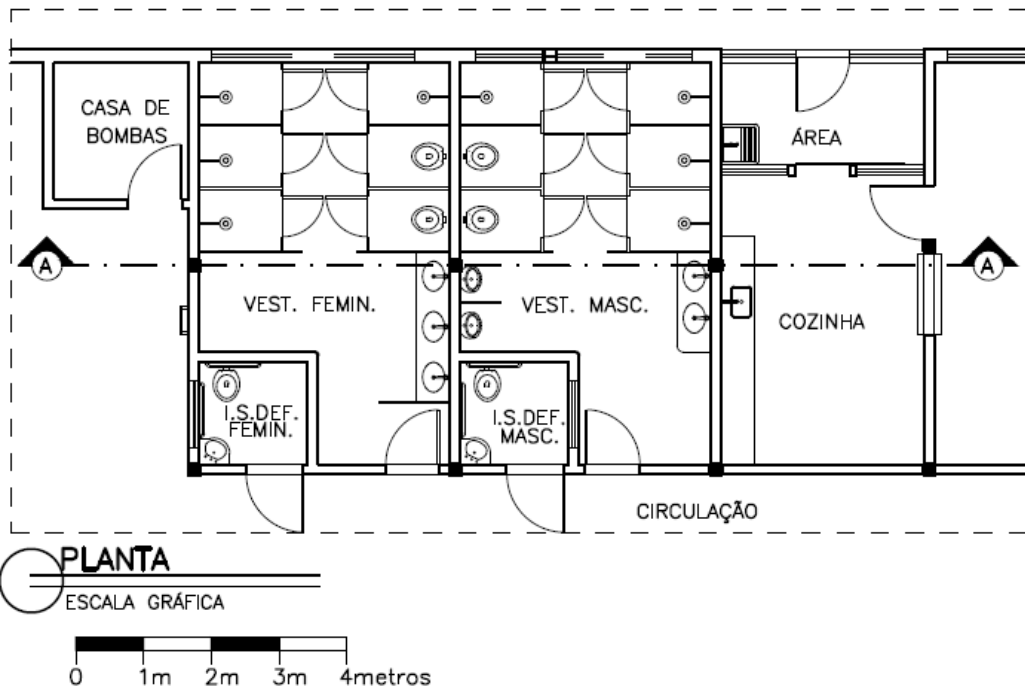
Planta Baixa do trecho dos vestiários extraído do Projeto Arquitetônico.
